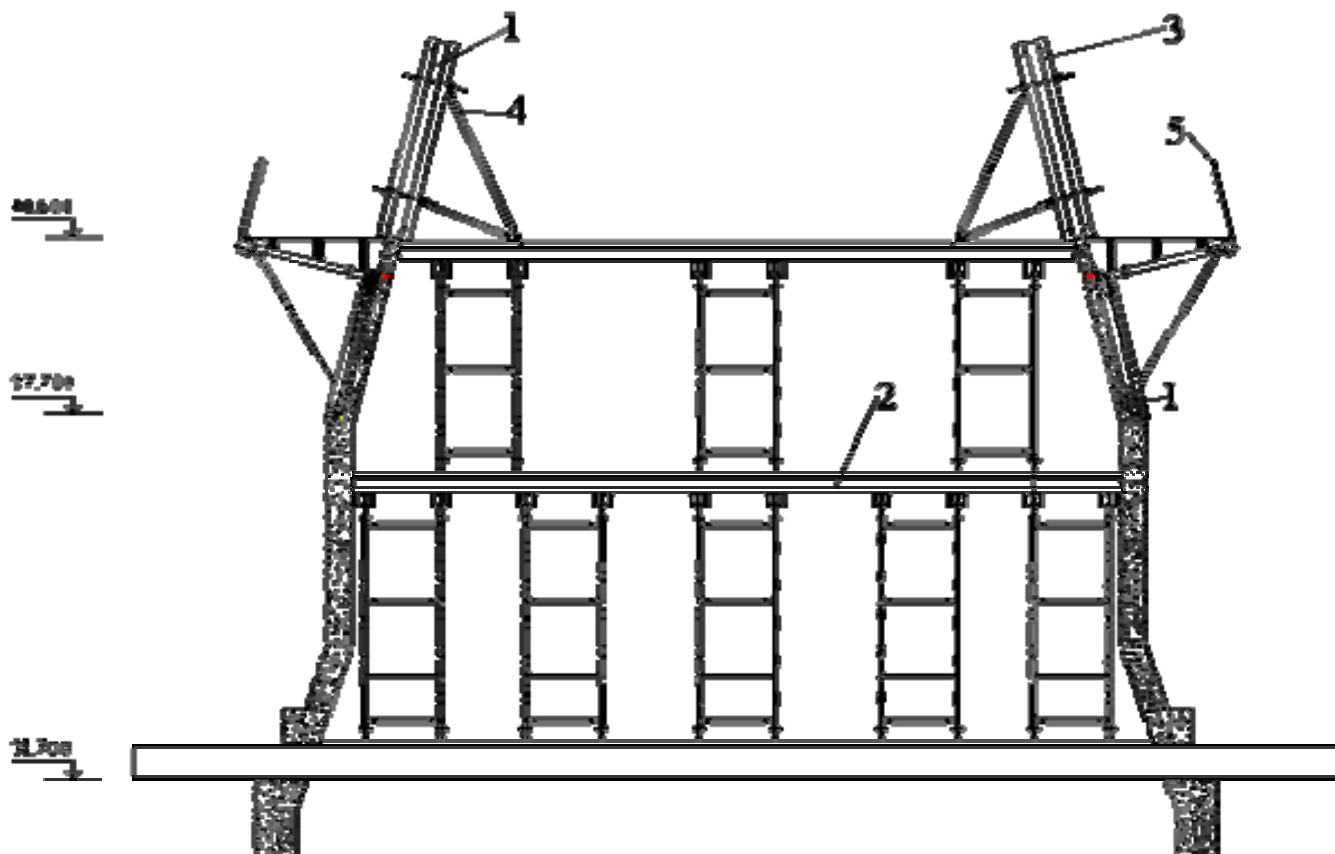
Схема опалубки для возведения монолитных конструкций шатра Храма в Честь Всех Святых и безвинно убиенных в Отечестве нашем (г. Минск)
